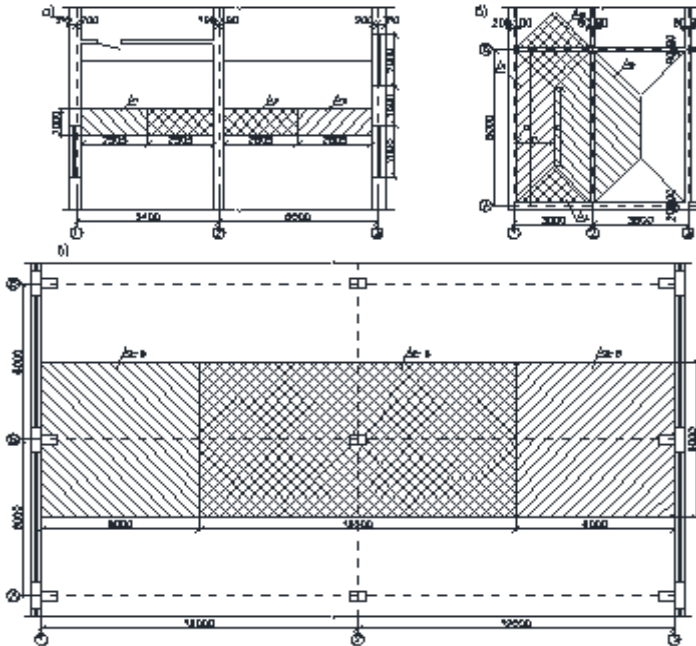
Схема визначення вантажної площі: а) опирання плит перекриття на поздовжні (поперечні) несучі стінці; б) опирання плит перекриття по контуру; в) каркасно-конструктивна схема будівлі
